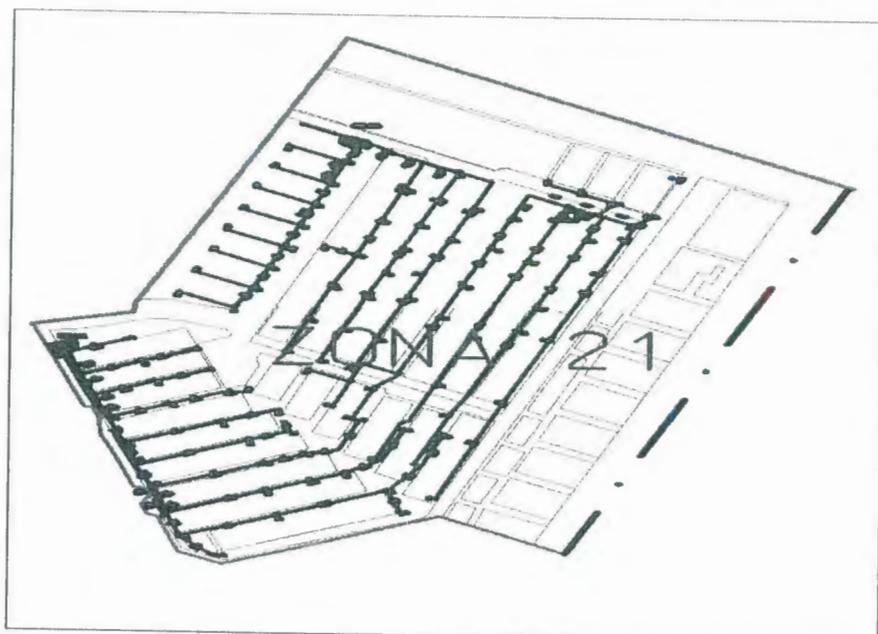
Planimetría zona 21 del sector de la vía a Daule
